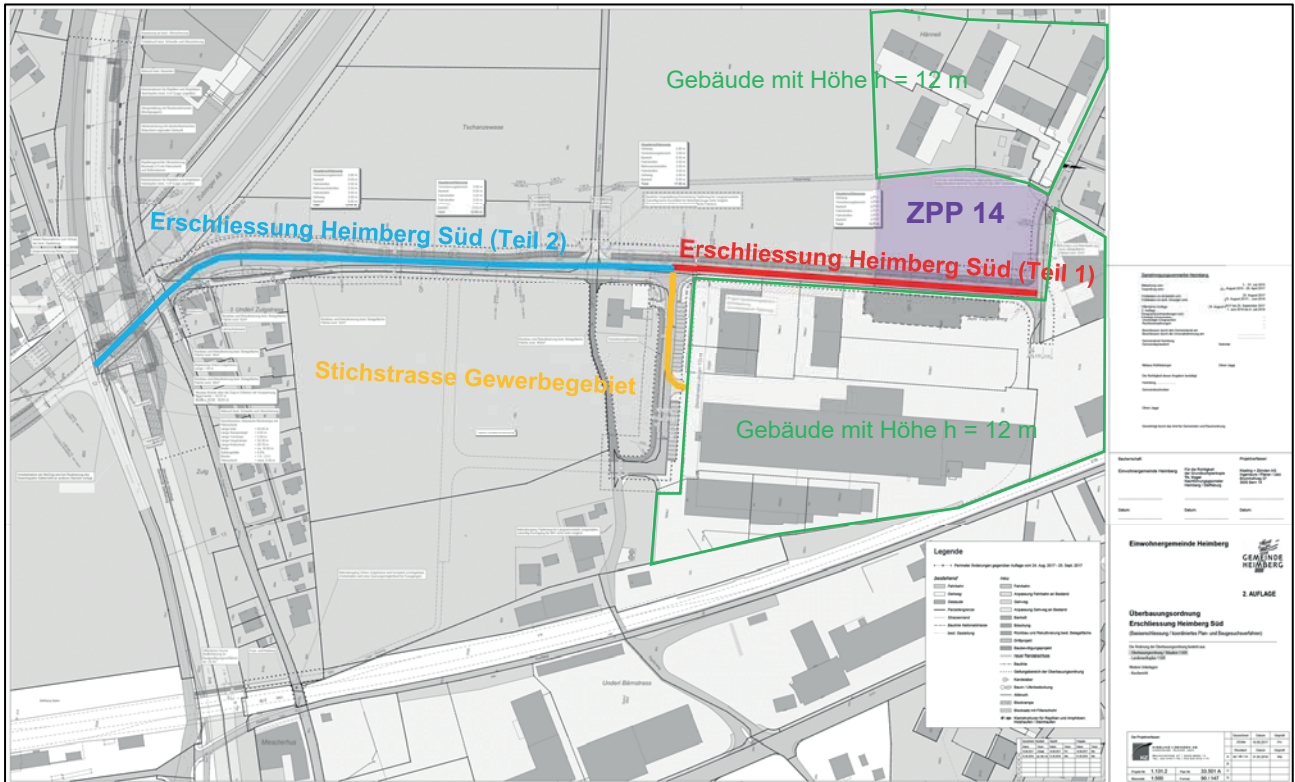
Auszug aus Situationsplan ÜO Erschließung Heimberg Süd, unmasstäblich
